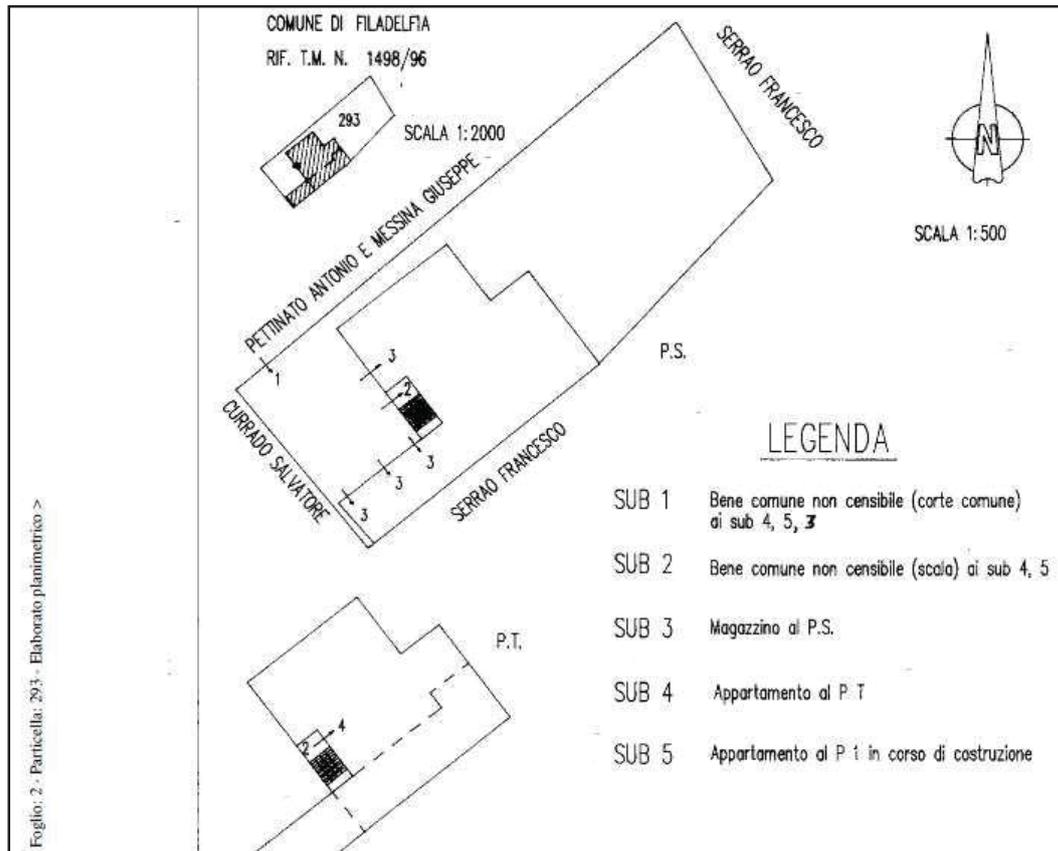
elaborato planimetrico part. 293 in testa a Serrao Francesco
